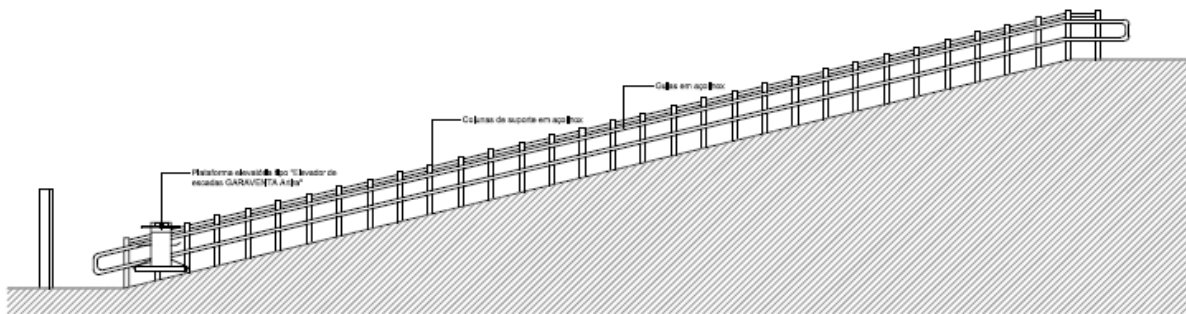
Pormenor de Acesso através de Plataforma Elevatória
